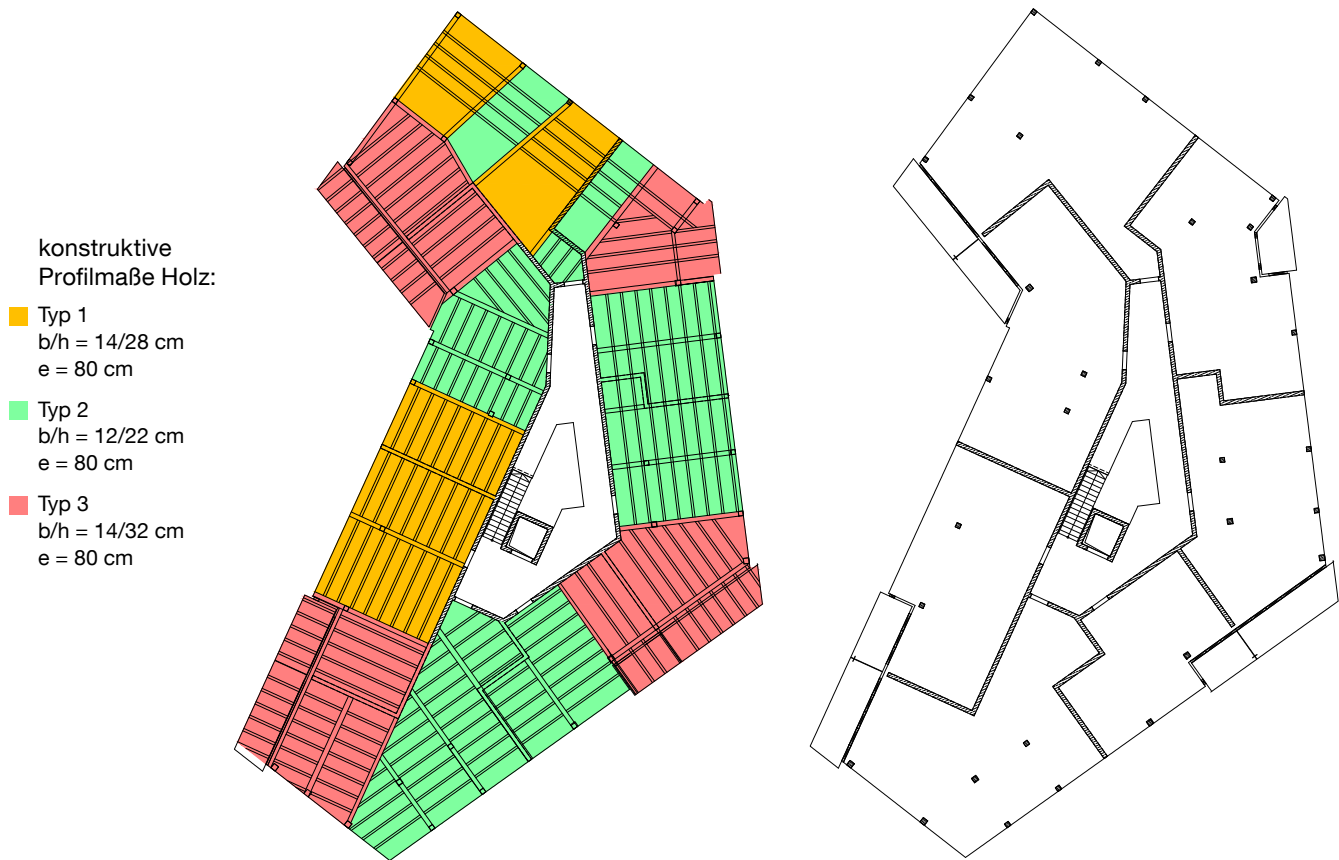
Vergleich der Bauweisen am Regelgrundriss 1.OG Haus Asien: links: Holztragwerk, rechts: Stahlbeton-Tragwerk
